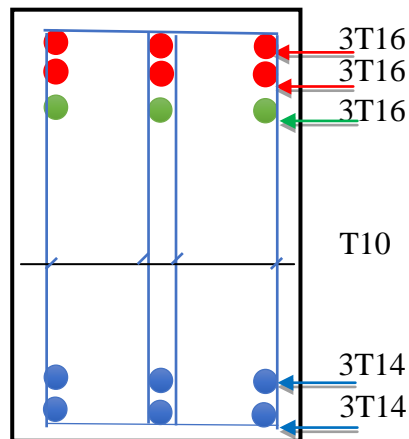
Ferrailage de la poutre de libage (sens transversal)
